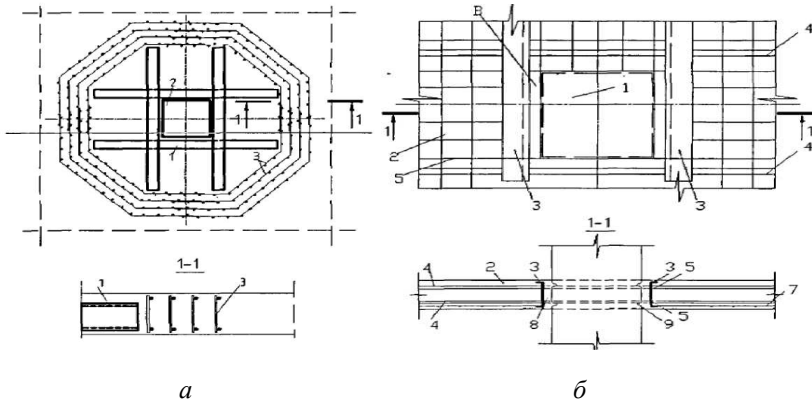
Армування вузлового з'єднання «плита–колона» жорсткою арматурою швеллерами:
